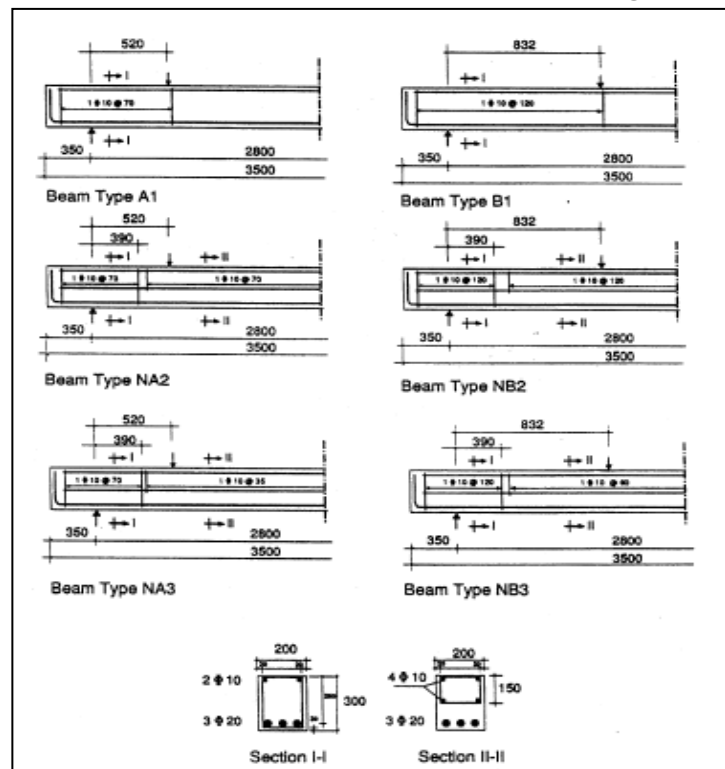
Comportement en flexion de poutre en béton confiné par des étriers [26]
